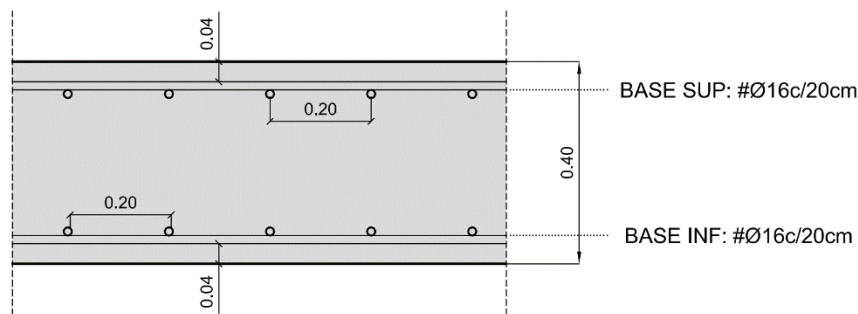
Sección de losa maciza de 40 cm de canto. Fuente: David Gallardo.
